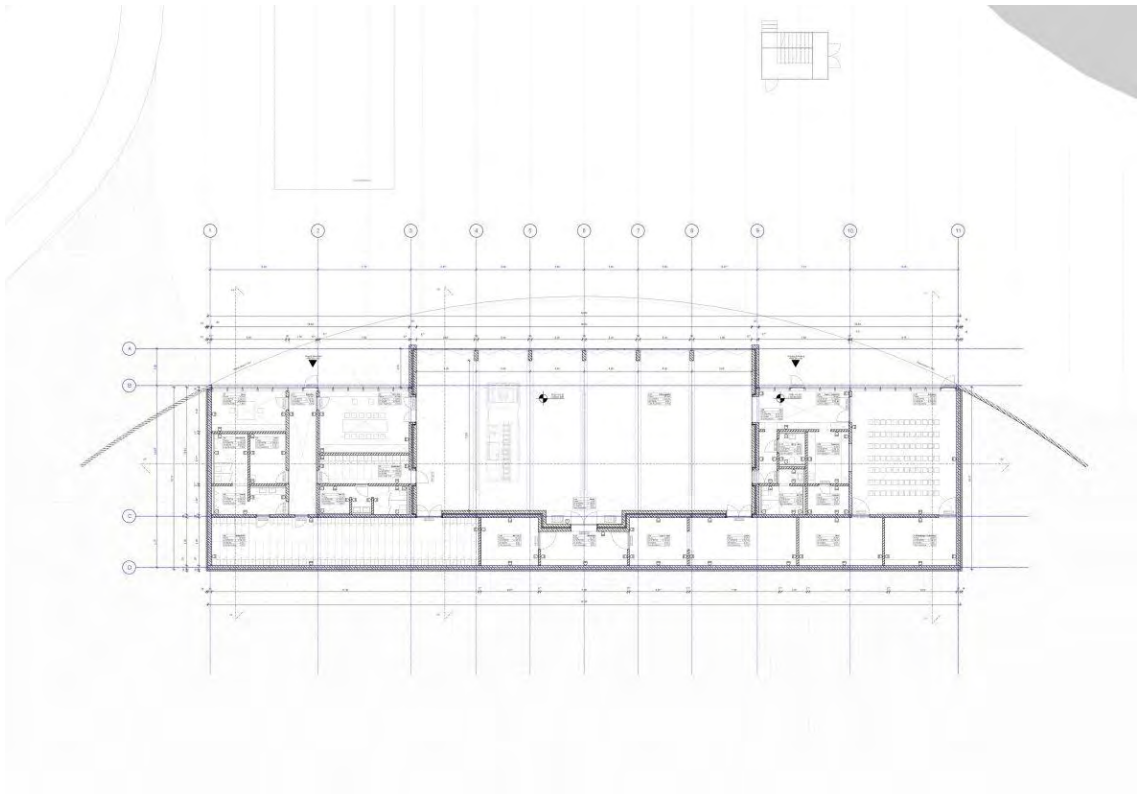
Grundriss des Feuerwehrgerätehauses, o.M. (Quelle: Steimle Architekten GmbH)
